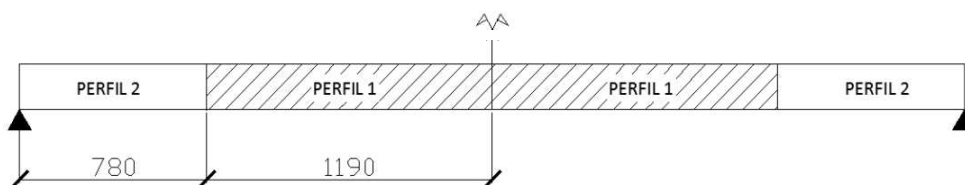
Distribuição dos perfis da longarina da ponte em vigas mistas para o vão de 40 m (adaptado de BELLEI e PINHO, 2007). Dimensões em mm.
